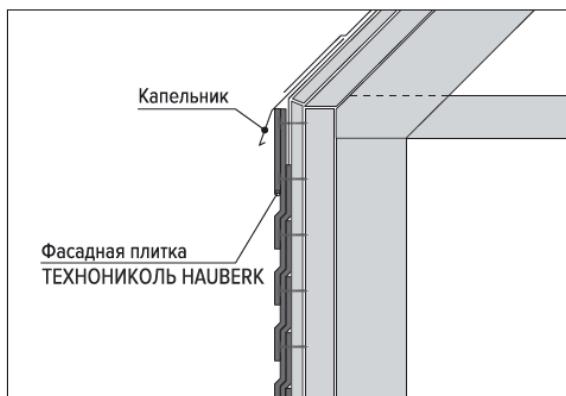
Монтаж верхнего ряда в домах без карнизного свеса
